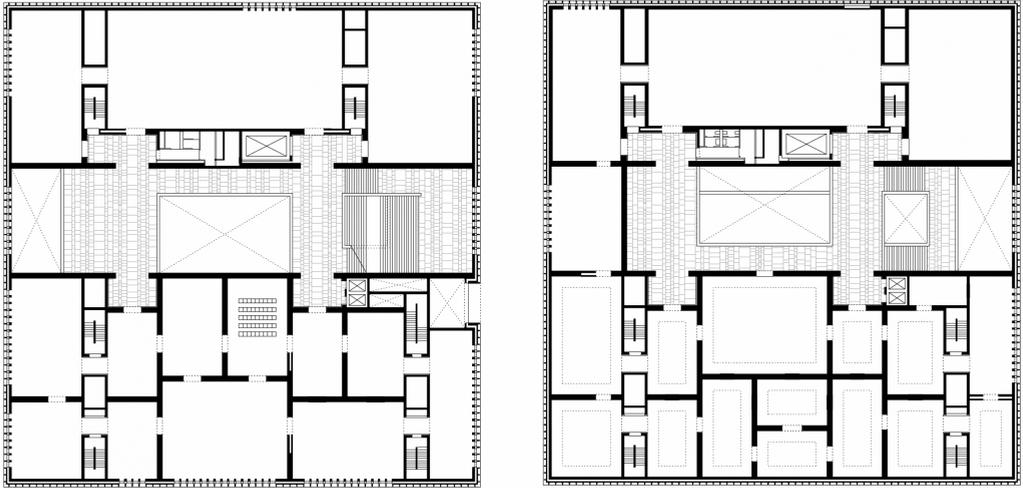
Kunsthhaus Zürich, Erweiterung, Grundrisse 1. und 2. OG
